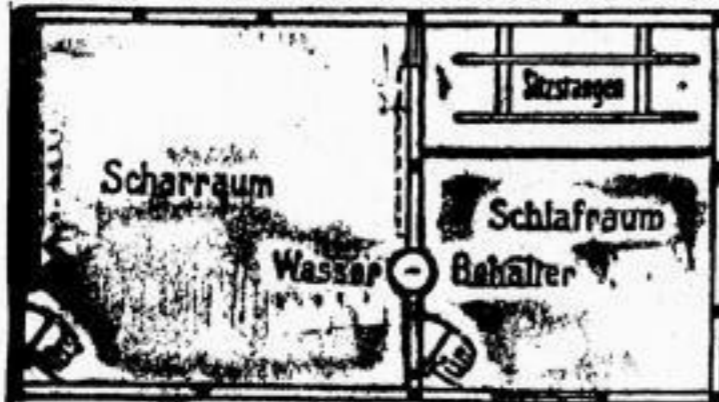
Grundriß eines vorzuziehenden Kaninchenstalles.
